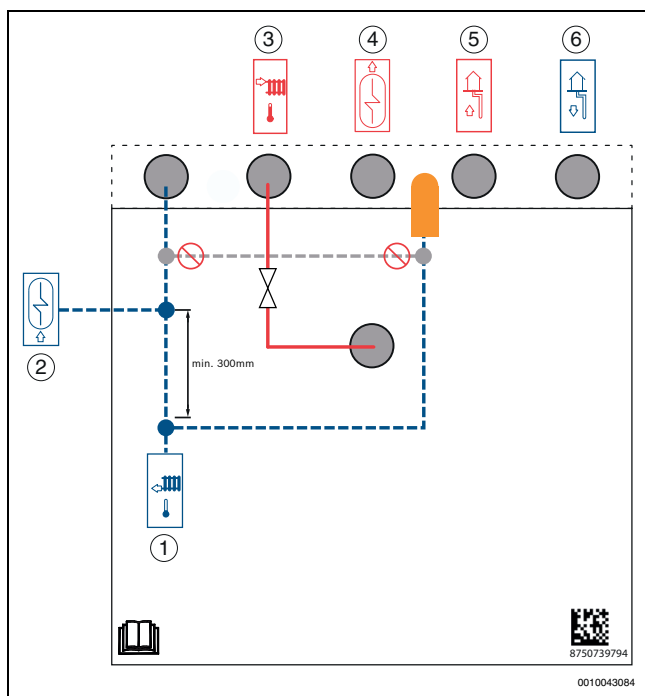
Principiální náčrtek - akumulční nádrž s tepelným čerpadlem
